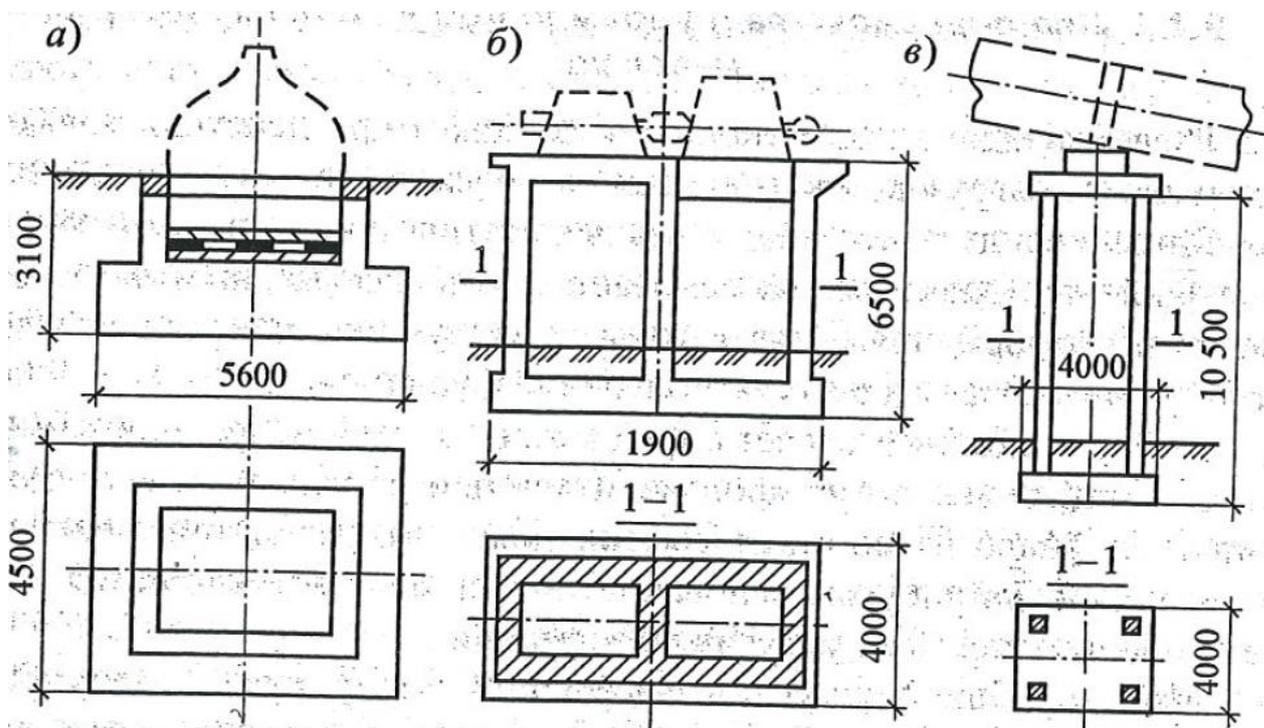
Примеры фундаментов при динамических нагрузках
